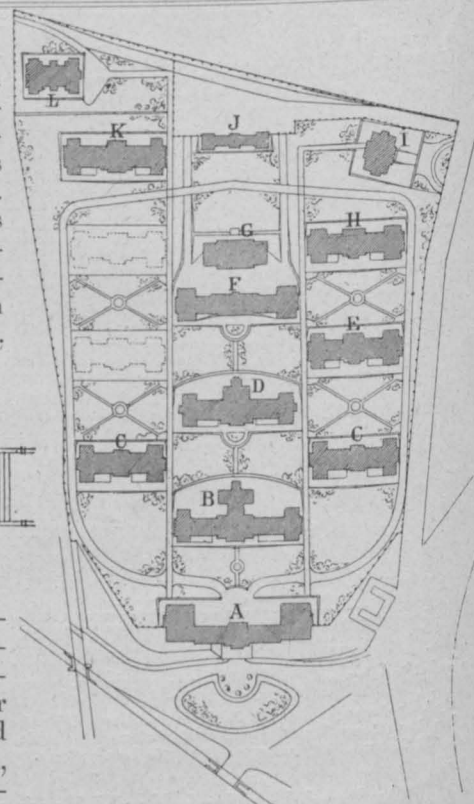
Lageplan des St. Johann-Spitals, Budapest.
